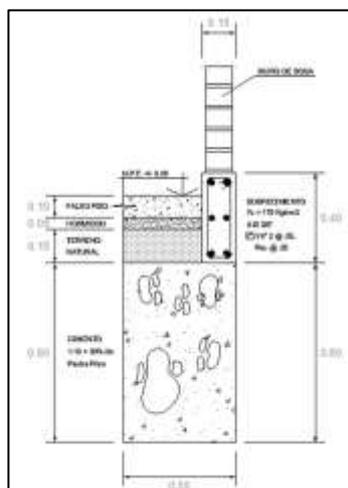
Sección 1-1, Cimiento corrido. FUENTE: Elaboración propia.
